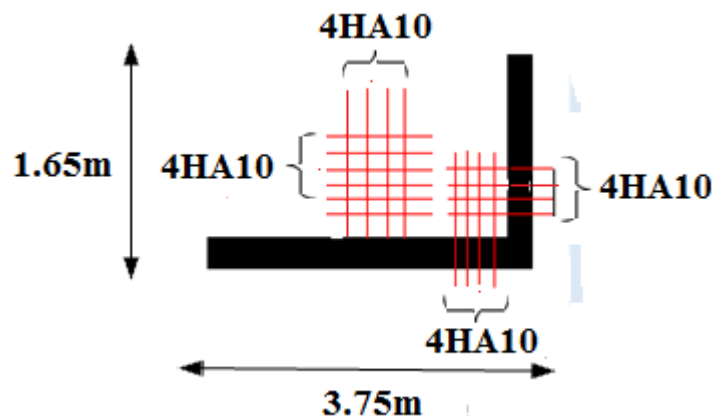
Schéma de ferrailage de la dalle pleine sur 2 appuis (balcon2).
